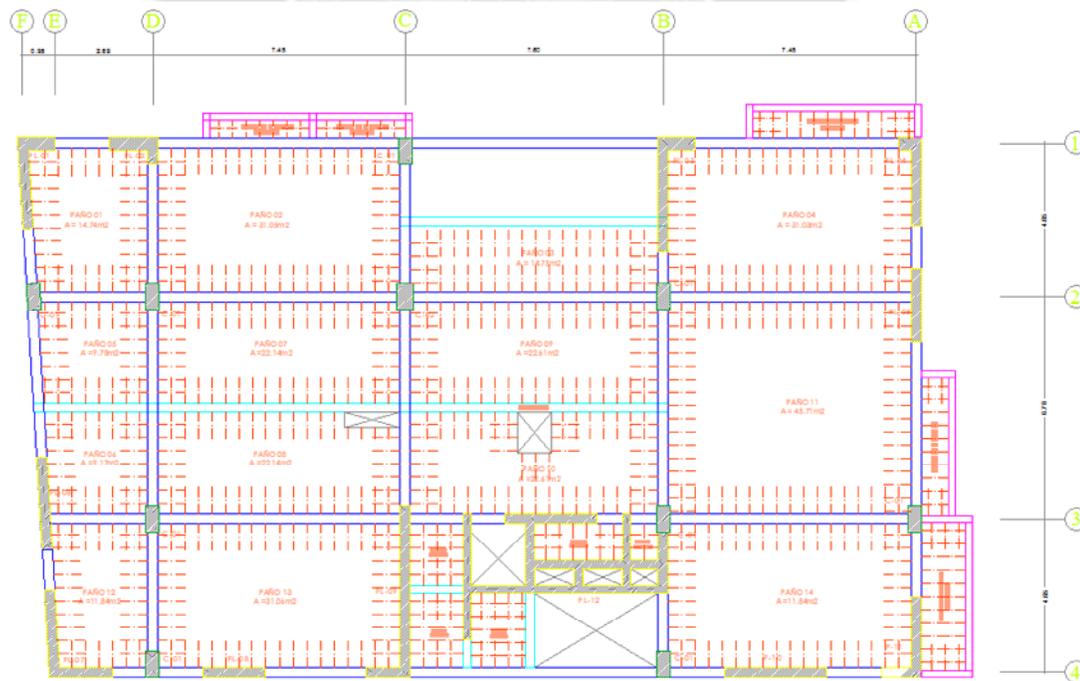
Dirección del Aligerado en Planta – 1ro, 3ro, 5to, 7mo piso.
